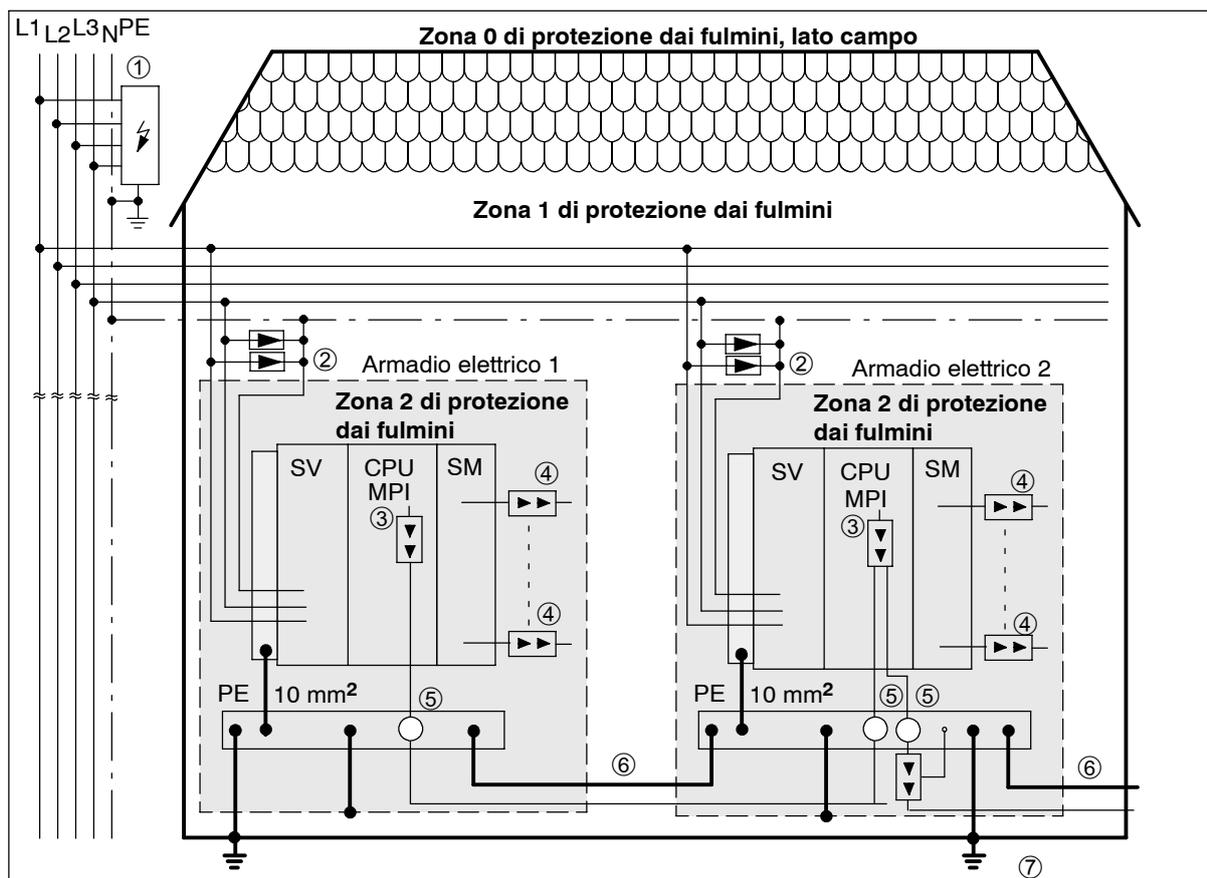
Esempio di corretta installazione di S7-400 collegati in rete
